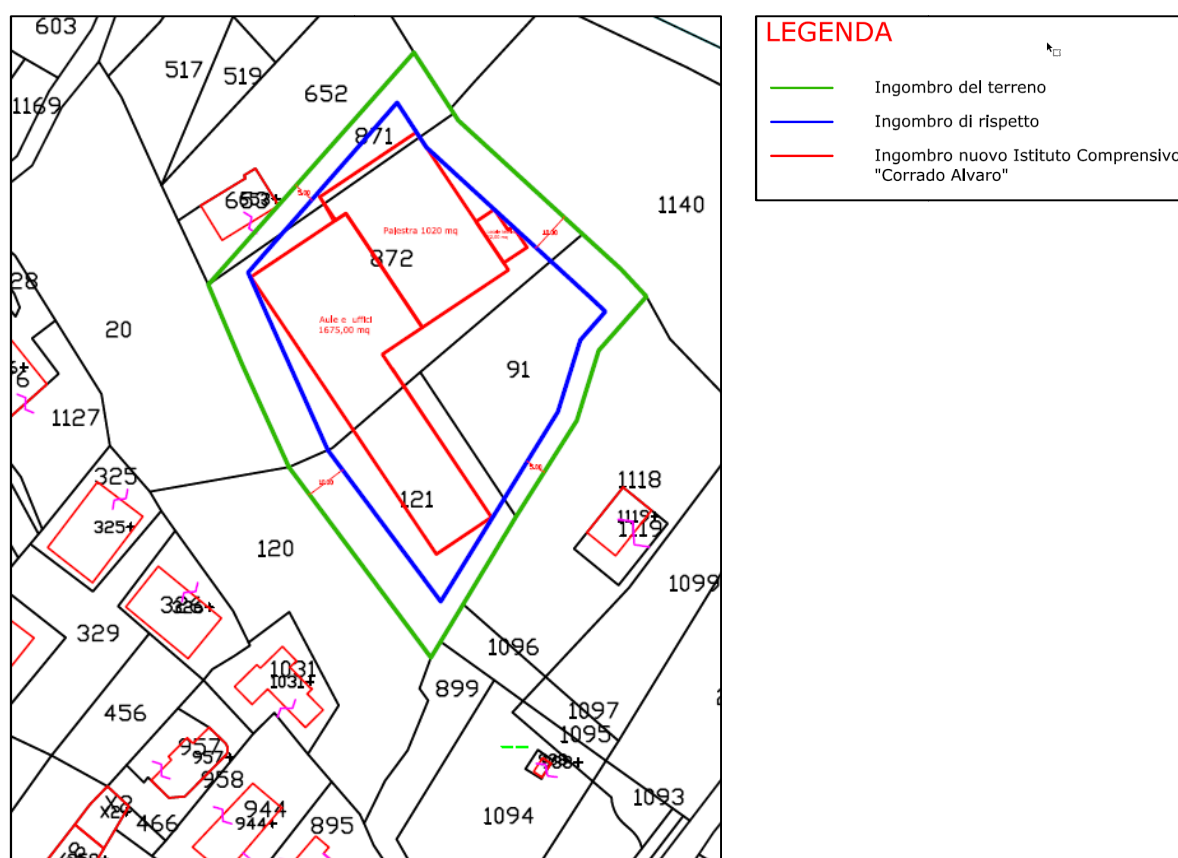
Stralcio planimetrico elaborato A13 "Planimetria generale e di rilievo" - Studio di Fattibilità – Planimetria catastale con ingombri
